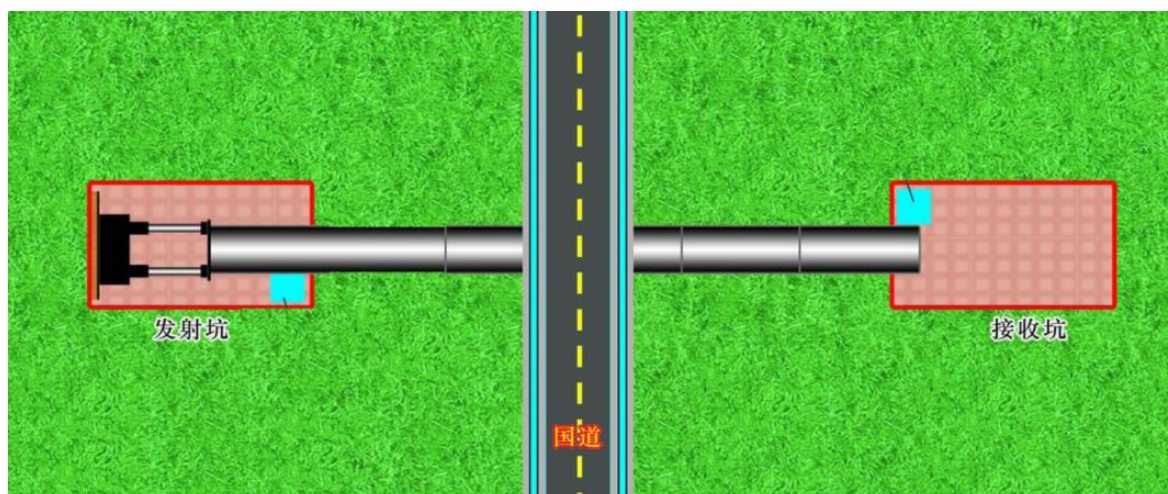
顶管穿越公路施工平面布置示意图
